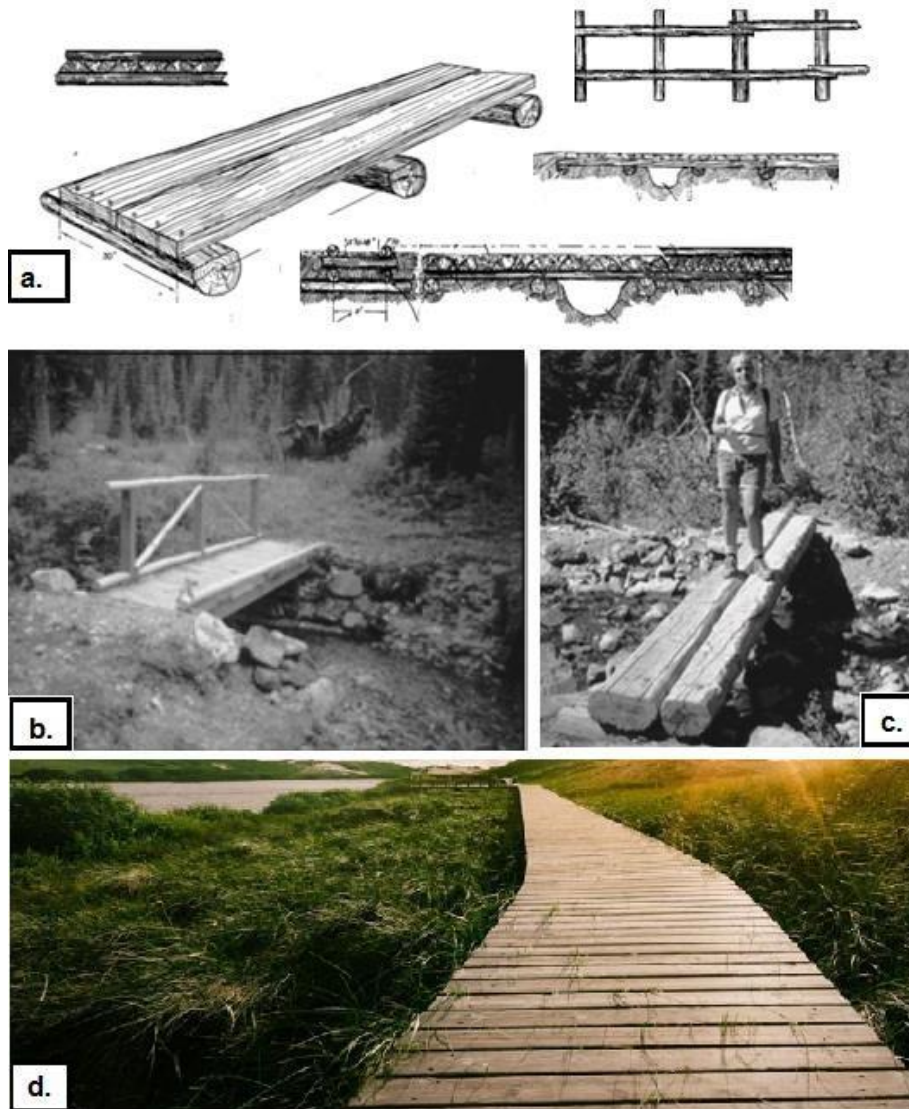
a) exemplo de passadiço e respetiva construção, b) e c) exemplos de pontes; d) outro exemplo de passadiço (Hesselbarth et al., 1996);
